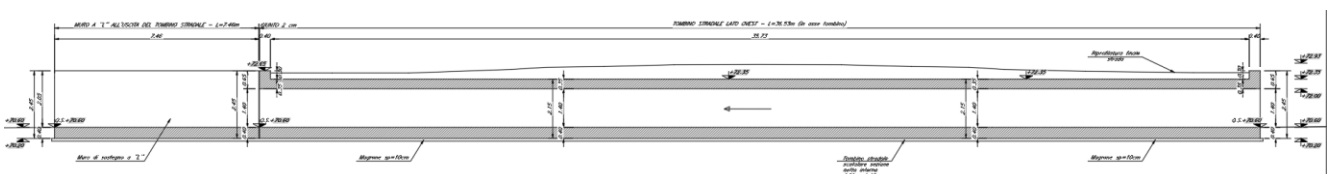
Sezione longitudinale tombino stradale ovest su via Bellini
